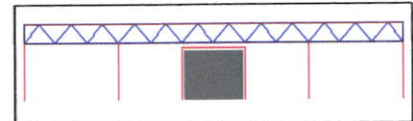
; Blocage sur voile ou palée de contreventement; source : <http://www.archistructur.org>
